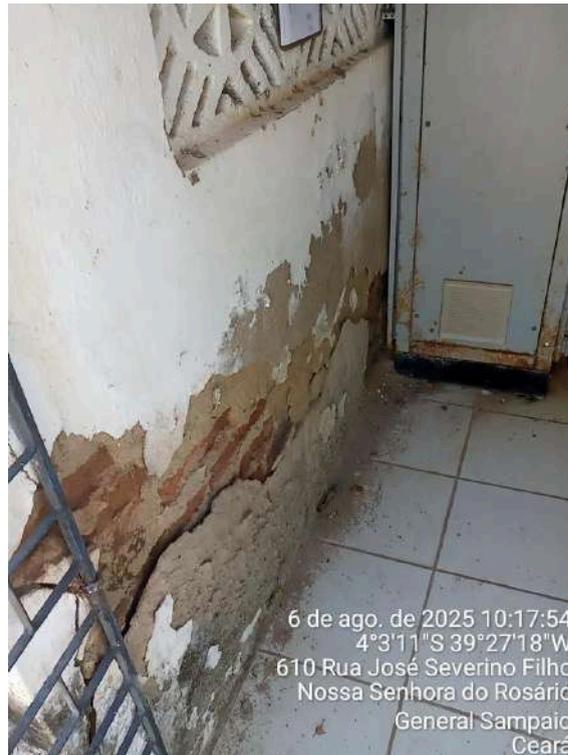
ETA/EELF: infraestrutura deteriorada.
